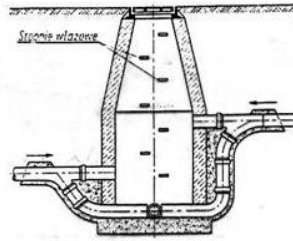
Betonowa studzienka połączeniowa o głębokości $> 3,0$ m (w przypadku lokalizacji w jezdni niezbędne jest oparcie płyty pokrywowej z włazem na pierścieniu podporowym wg rys. 10.32)
